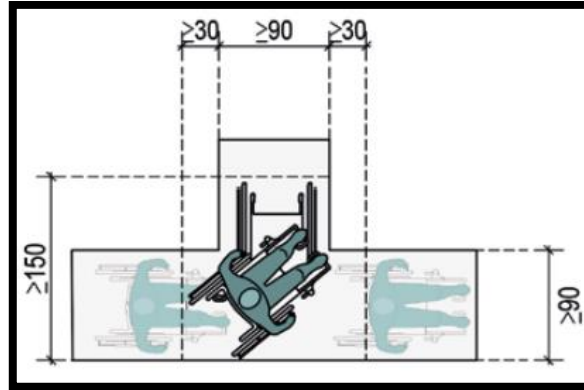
Hareket kısıtlılığı olan kullanıcıların geçiş genişlik ölçüleri (ASHB, 2021)
